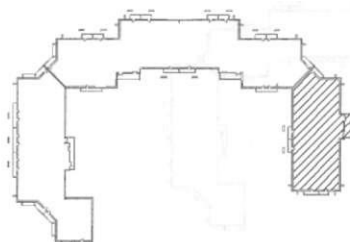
Расстановка стоек опалубки перекрытия на секцию типового этажа
